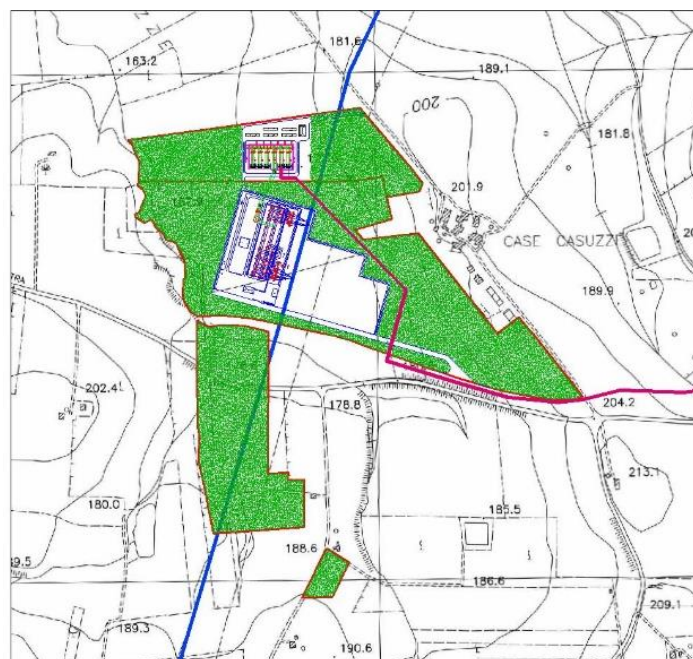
B – Layout della stazione ricadente sul territorio di Gibellina (TP - Contrada Casuzze) con cavidotto (TAV. IT-LAY)
